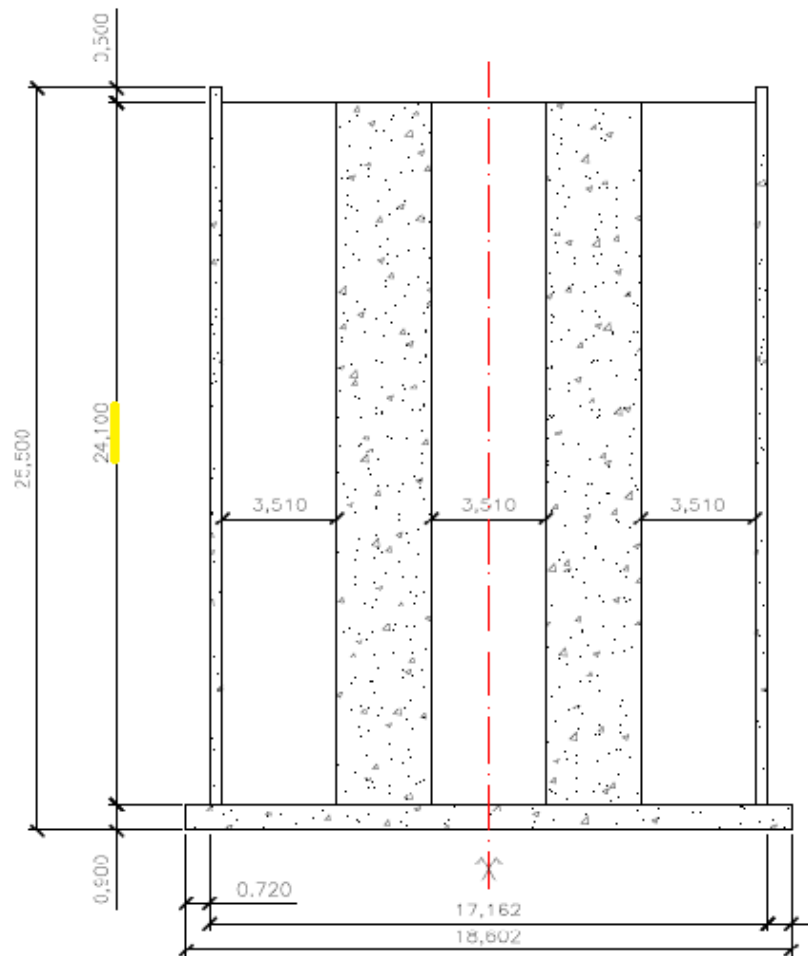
Plano en alzado del cajón “ALFA” [4]
